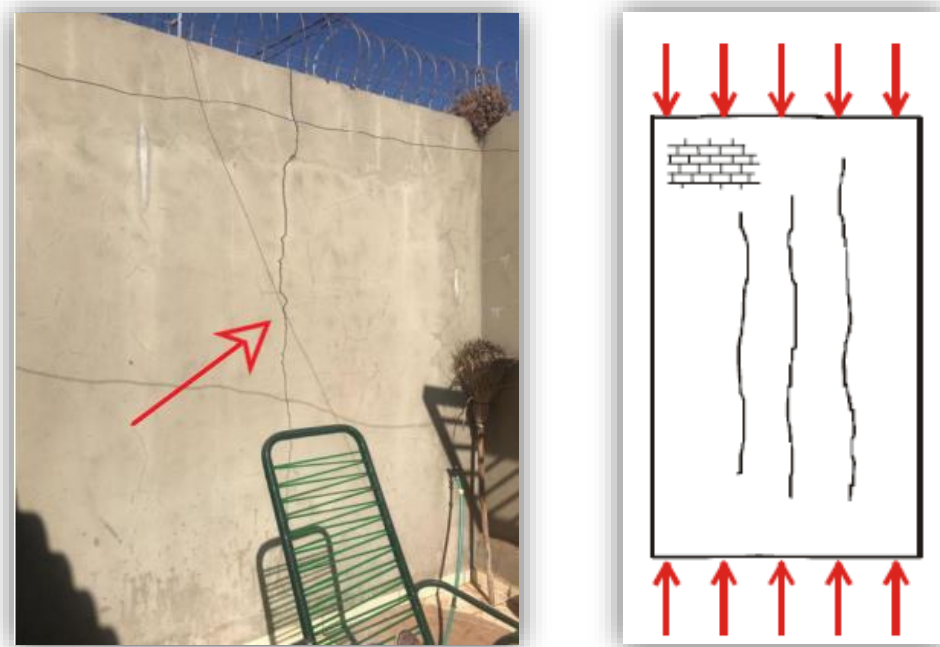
(a) Fissura vertical. (b) Fissuras verticais por sobrecargas. (Fonte: CAMARGO; ARANTES; SILVA, 2019. DUARTE, 1998).
